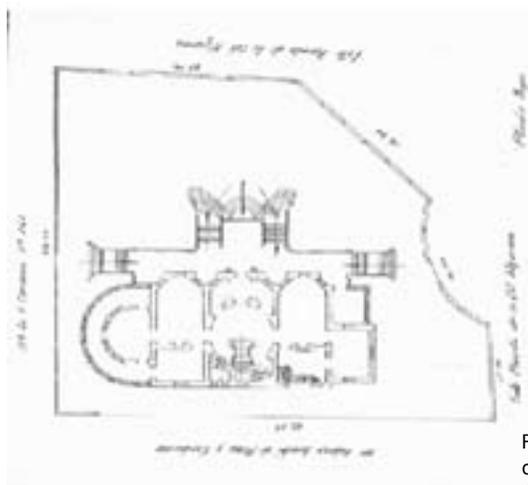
Planta baja de la casa “chinchas bravas” de José Morón.
